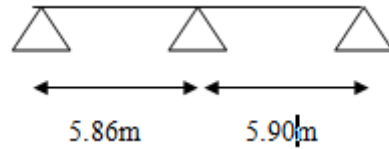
Schéma de 2<sup>em</sup> type de poutrelle
